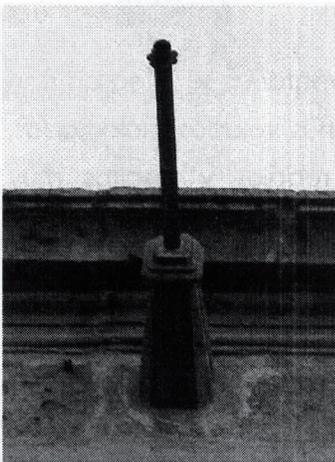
Cornisamiento moldurado y gárgolas, Fachada
